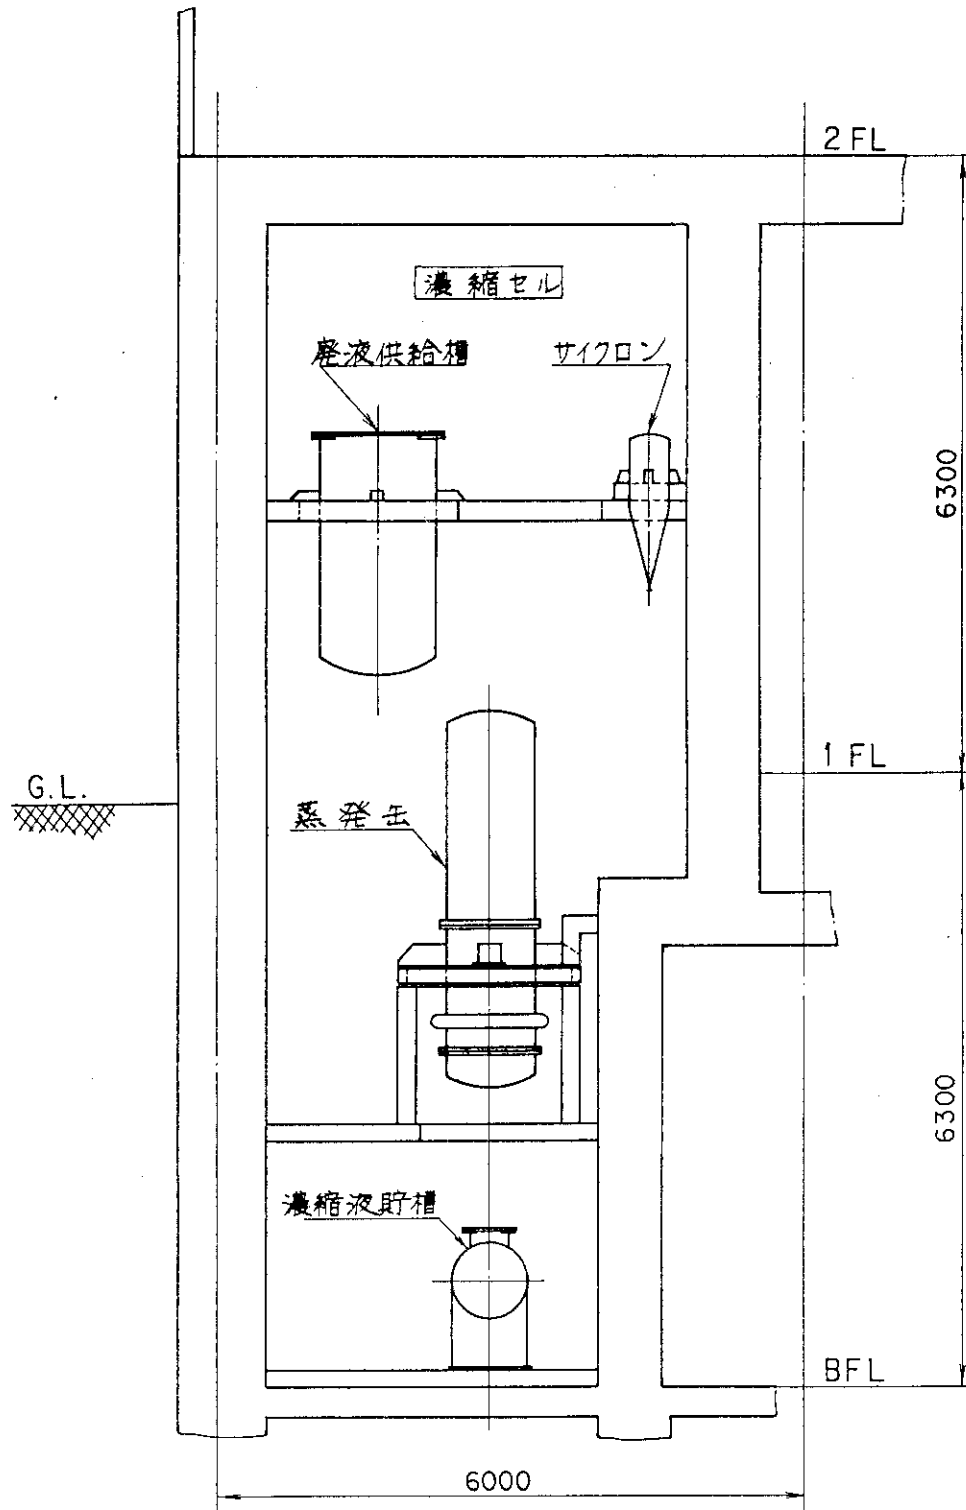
蒸発処理設備機器配置図 (その 4) 濃縮セル断面
